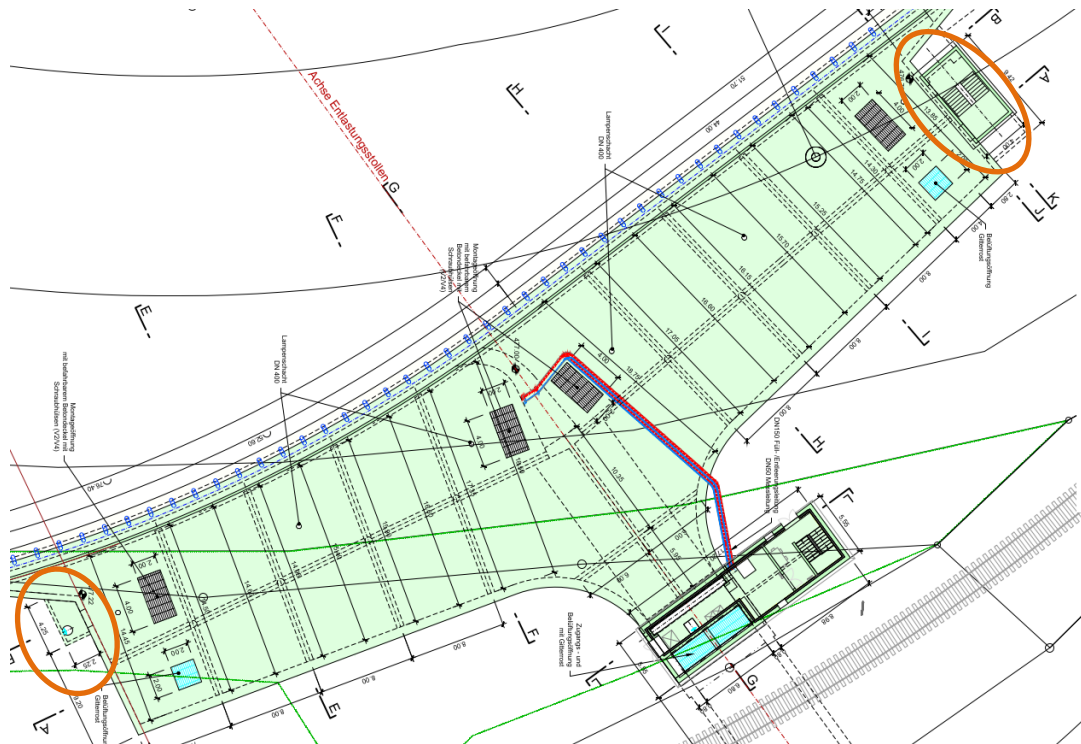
Zugänge in das untere Niveau des Einlaufbauwerks
